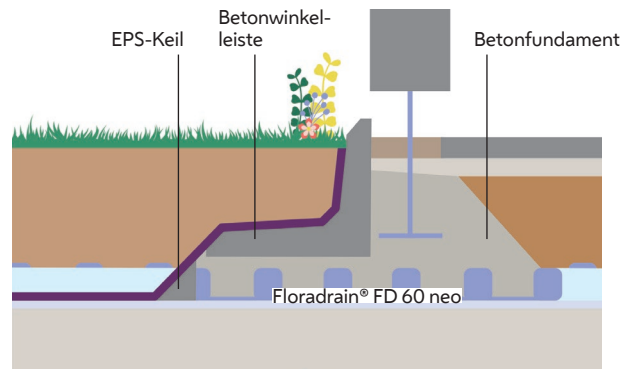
Auflastverankerung mit einem Betonfundament aus Ort- und Fertigbeton (GREEN4CITIES nach ZINCO, 2024)
